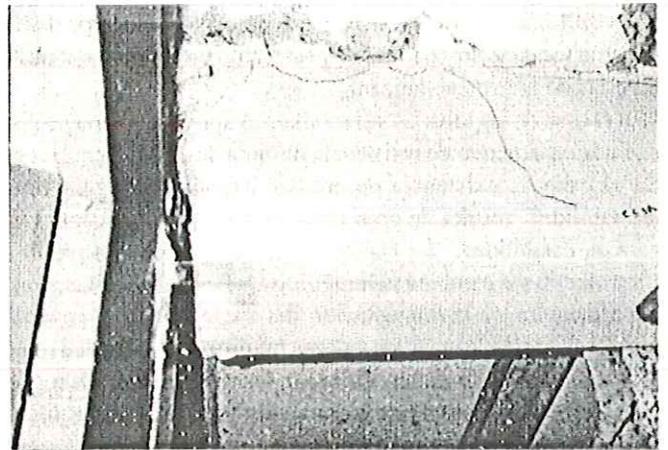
Muestra de fisuración de pantallas y vigas centrales de edificios con asentamientos diferenciales
